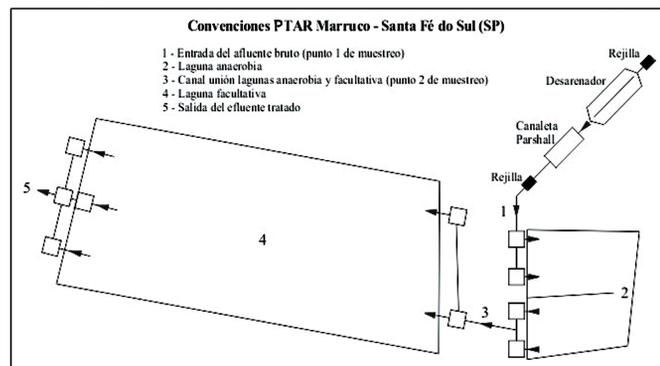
Vista en planta de la PTAR de Santa Fé do Sul con los puntos de muestreo.
